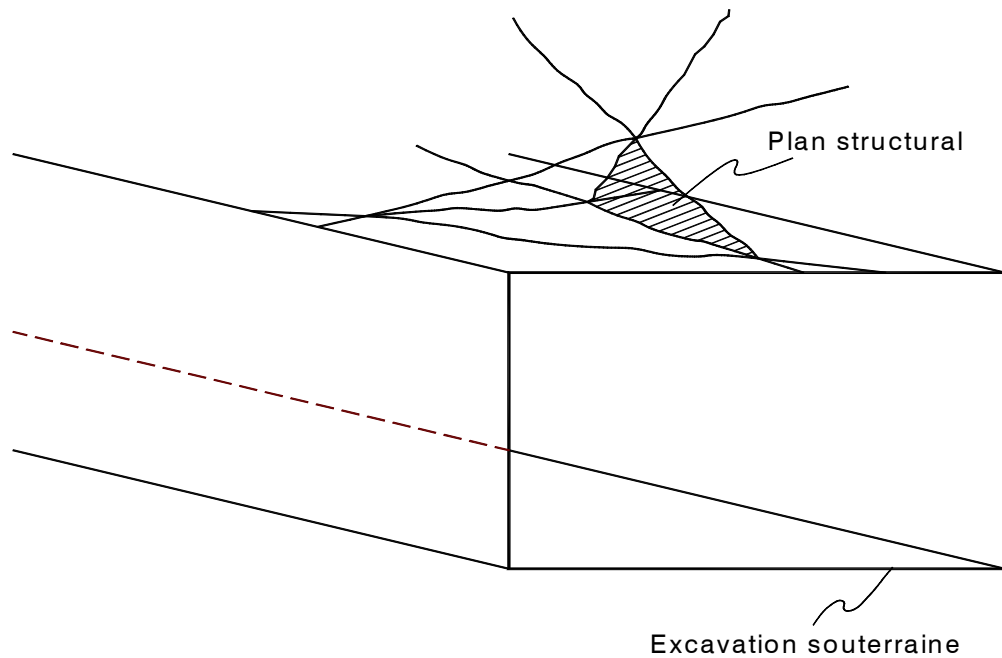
Tétraèdre complètement exposé, formé par trois plans structuraux qui se rencontrent à proximité du toit d'une voie horizontale.
